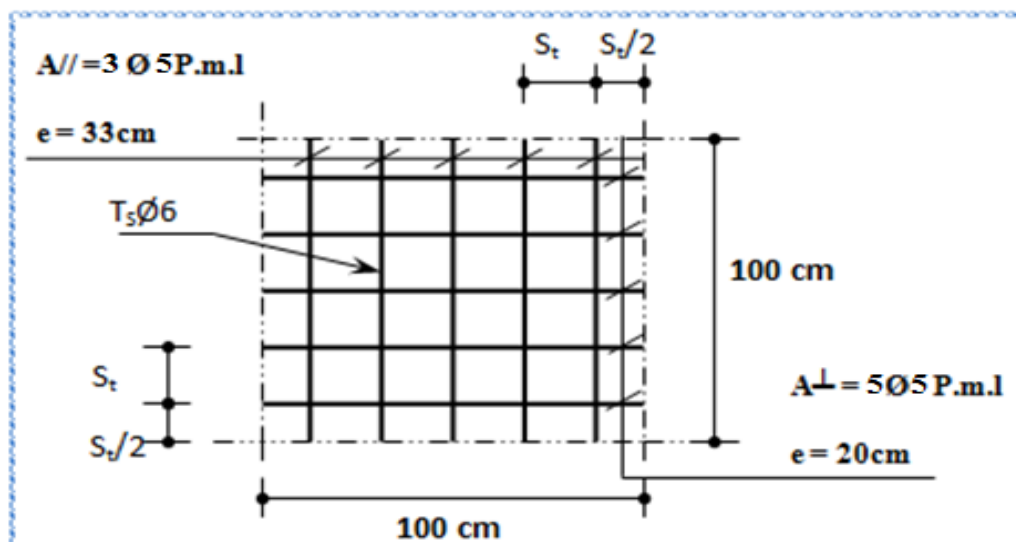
Disposition constructive des armatures de la dalle de compression
